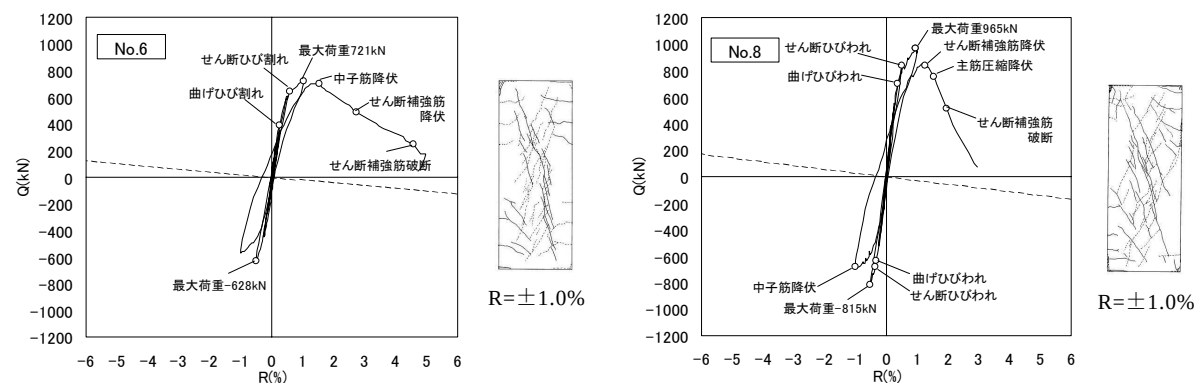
層間変形角(R)－層せん断力(Q)関係 および ひび割れ発生状況 (せん断破壊試験体)
